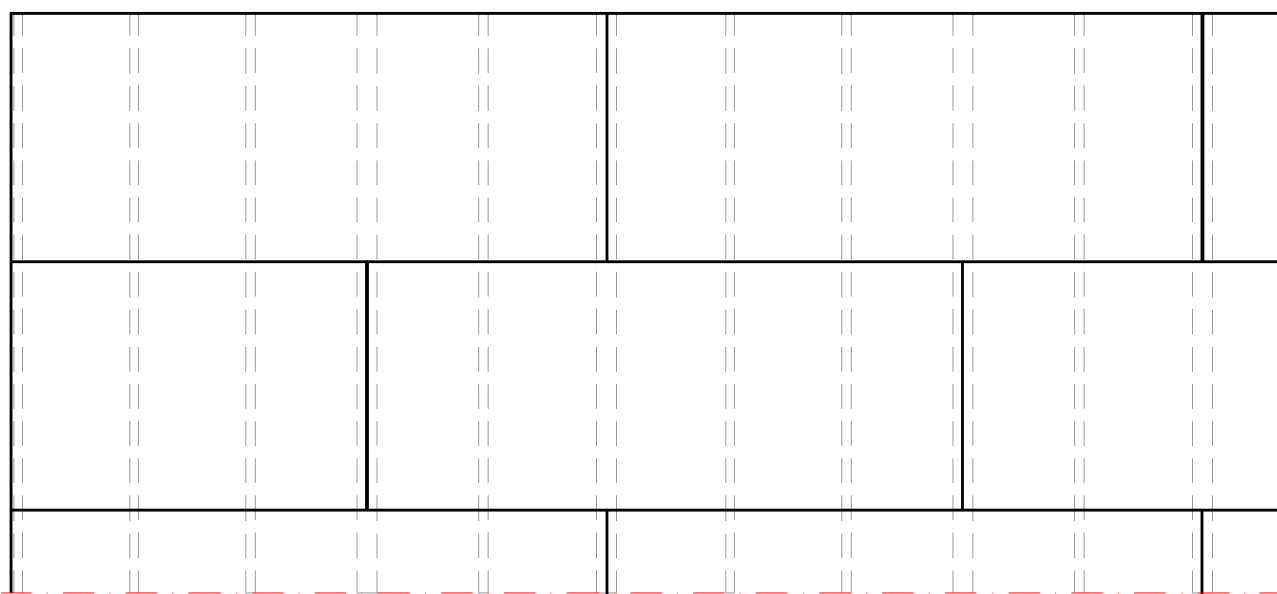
Disposição dos painéis, apoiados sobre vigas
